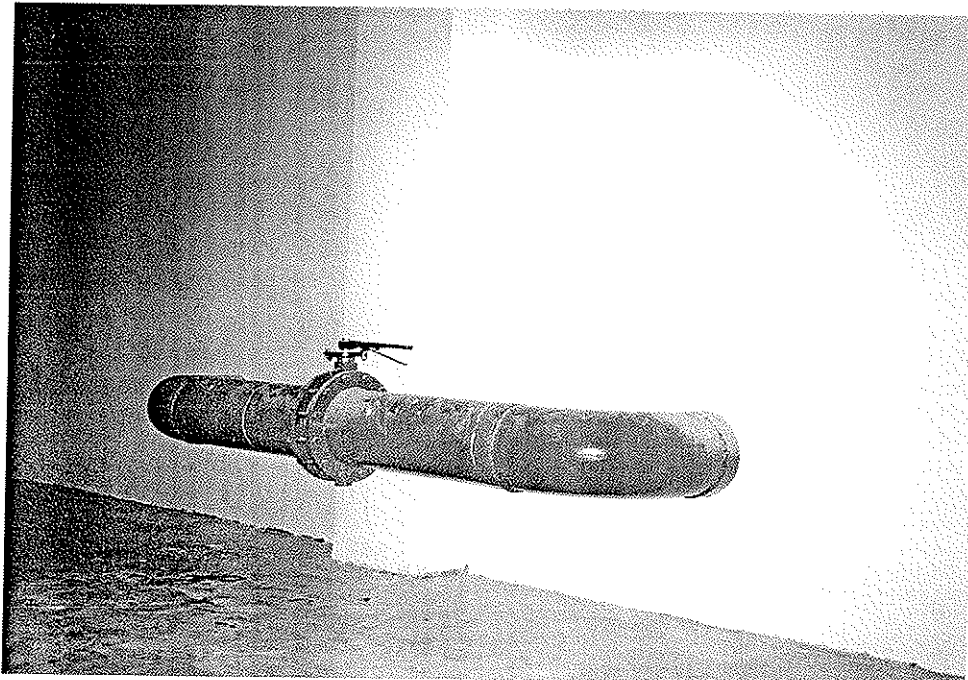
Pipa Hidrant dan Pipa Sprinkler
